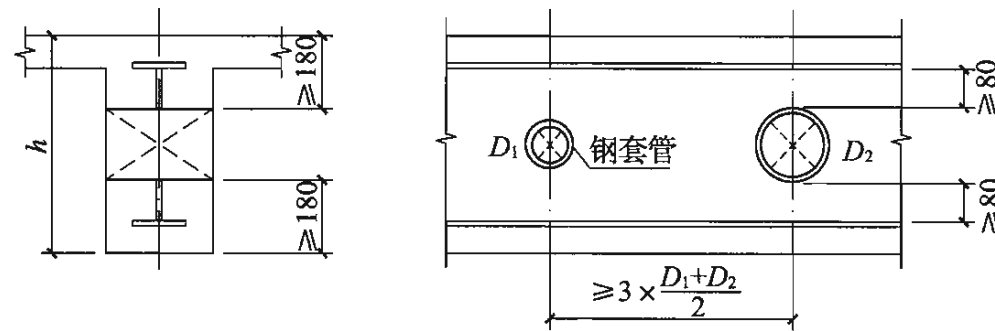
型钢混凝土梁的开孔尺寸、间距要求及钢套管
